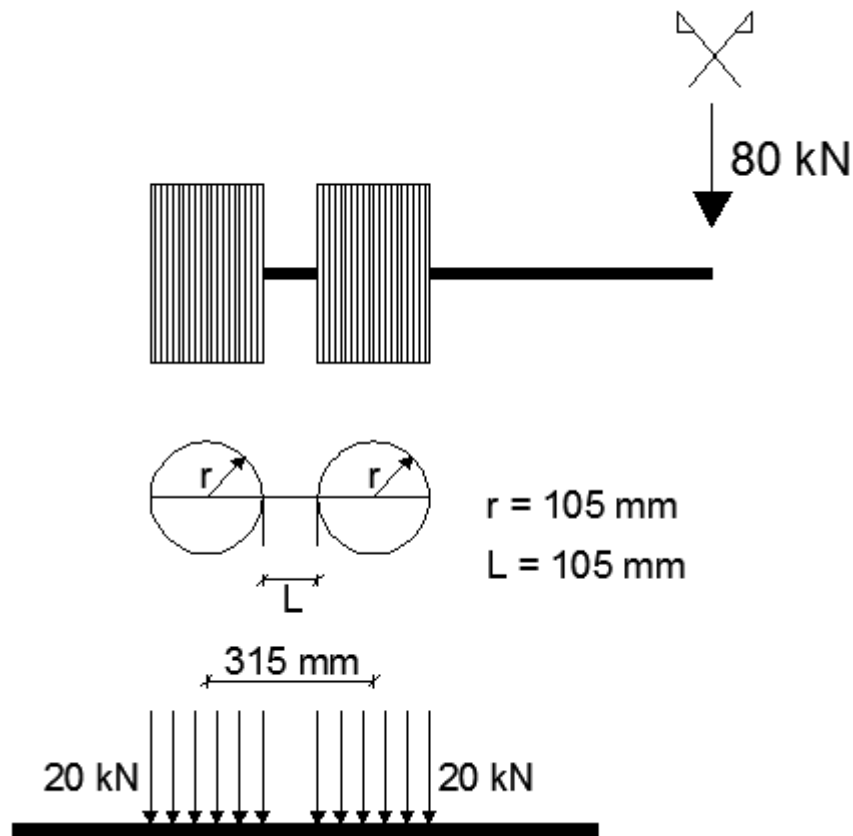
Esquema adotado para a ação de um eixo padrão sobre o pavimento
